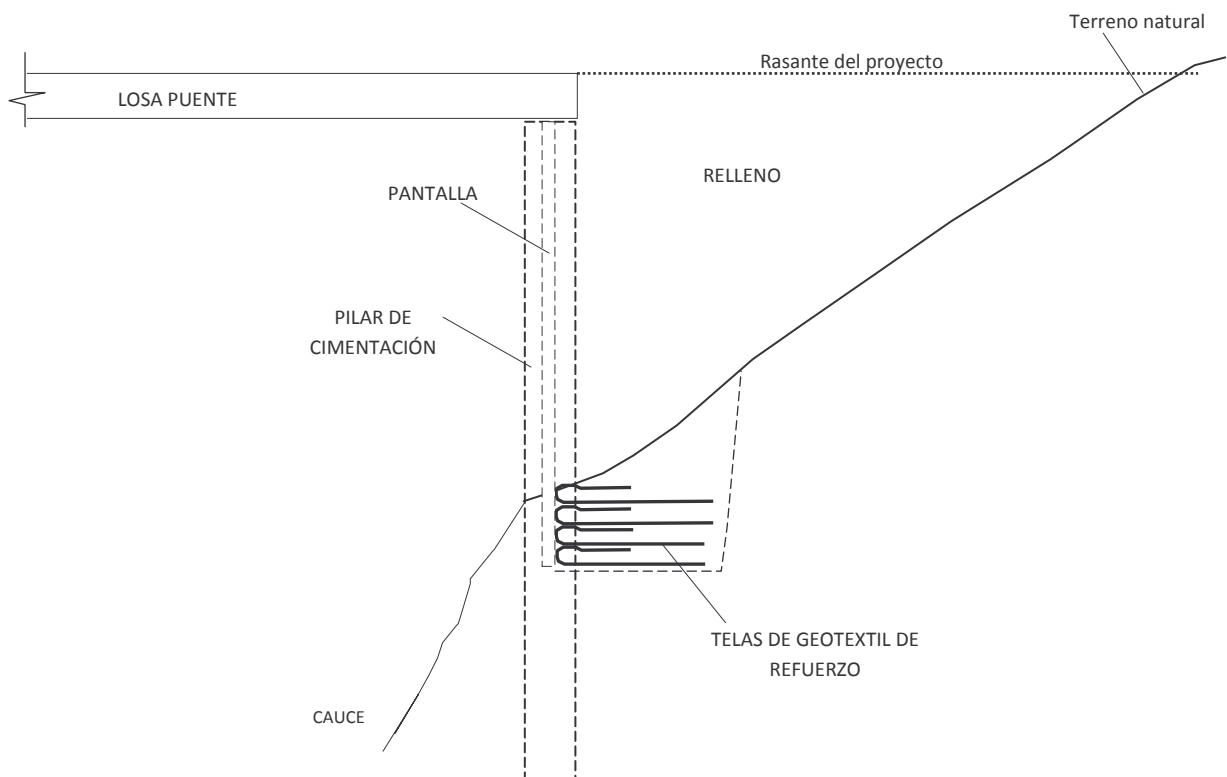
DETALLE DEL GEOTEXTIL DETRÁS DE LAS PANTALLAS
